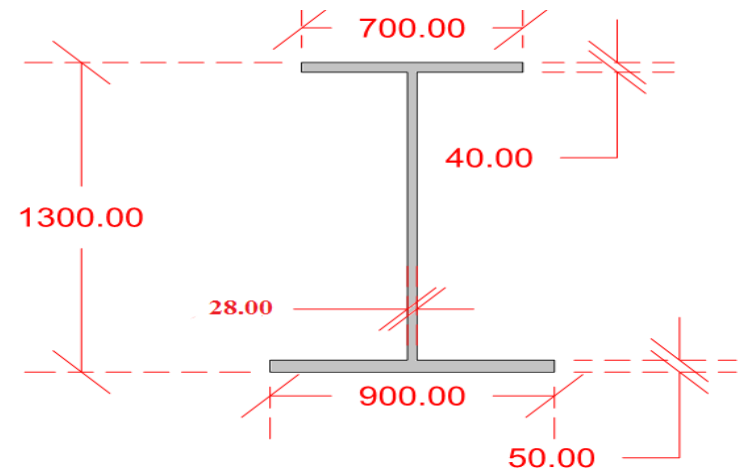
Détails de la poutre (section à mi- travée) –variante1
